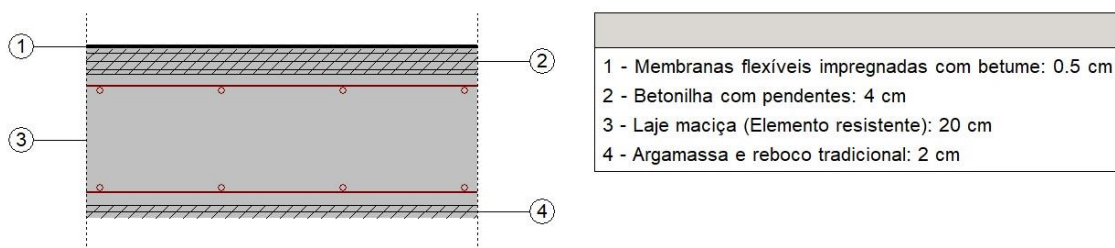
Pormenor construtivo da cobertura, com a solução construtiva inicial
